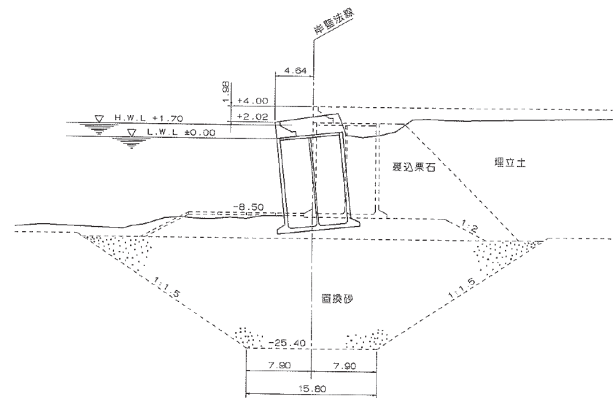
対象岸壁の被災状況断面図 (稲富ら⁷⁾)
